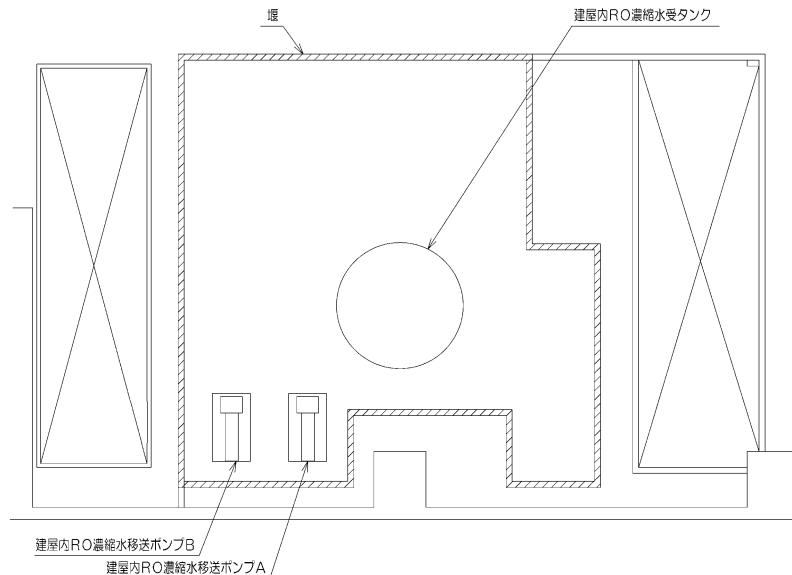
建屋内 RO 濃縮水受タンクの漏えい拡大防止 堰配置図
